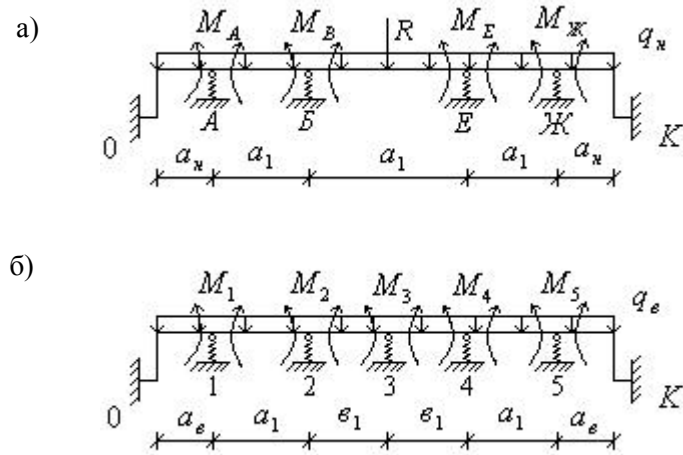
Расчётная схема двухъярусной балочной грубчатой конструкции:
